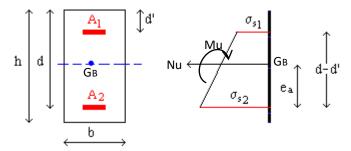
Flexion composée, section rectangulaire et N effort de traction.
